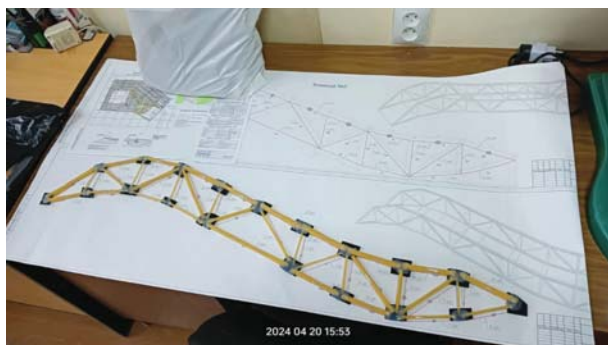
Схема для сборки макета и изготовленная ферма из макарон
